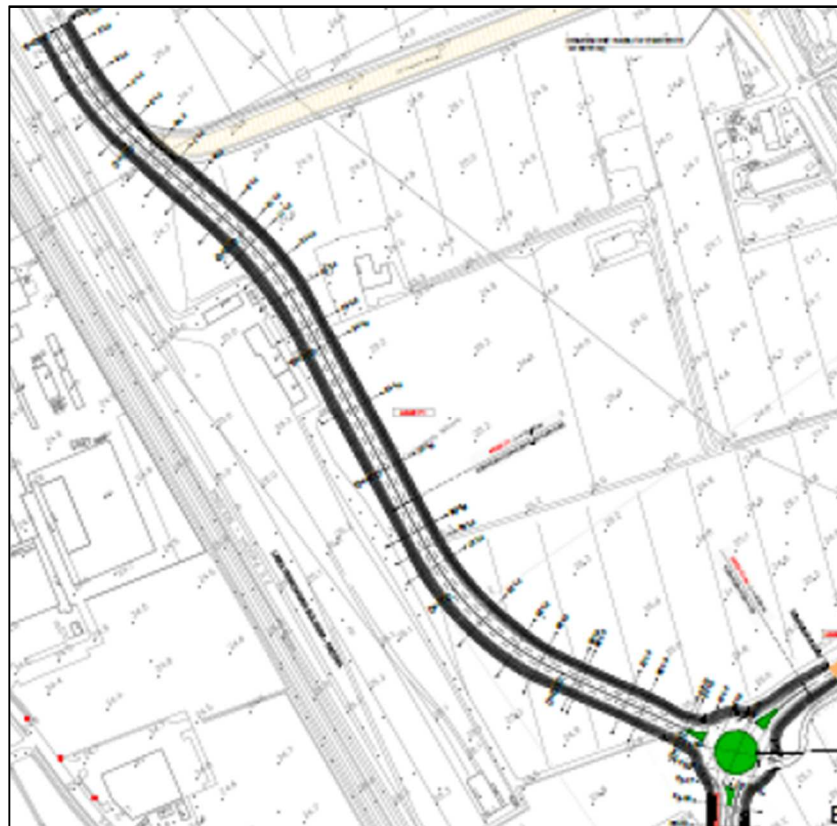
Stralcio planimetrico asse F1 interporto e rotatoria R14.
